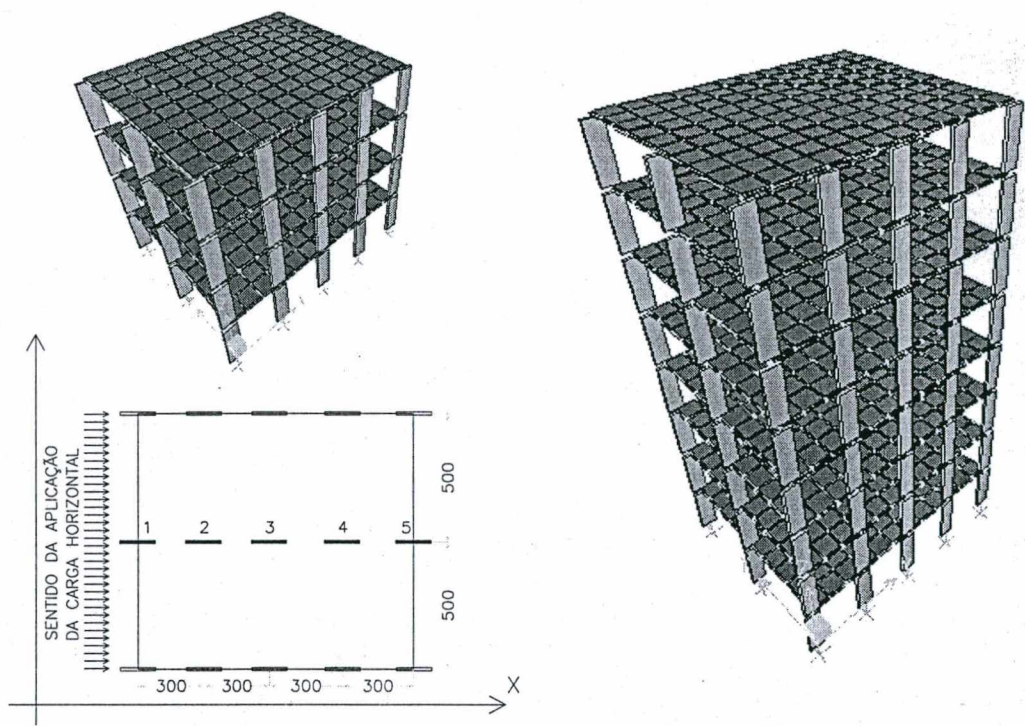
Perspectiva e planta baixa dos edifícios 10x12m com 4 e 8 pavimentos
